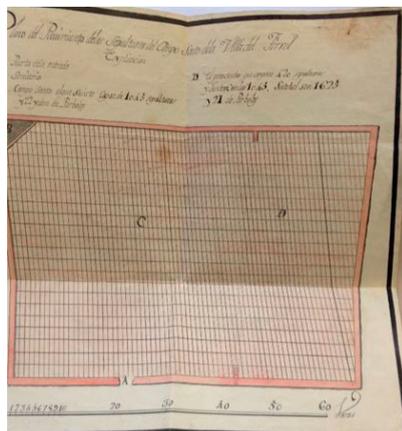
AMF C 474 Expte 6. Planta do cemiterio.
